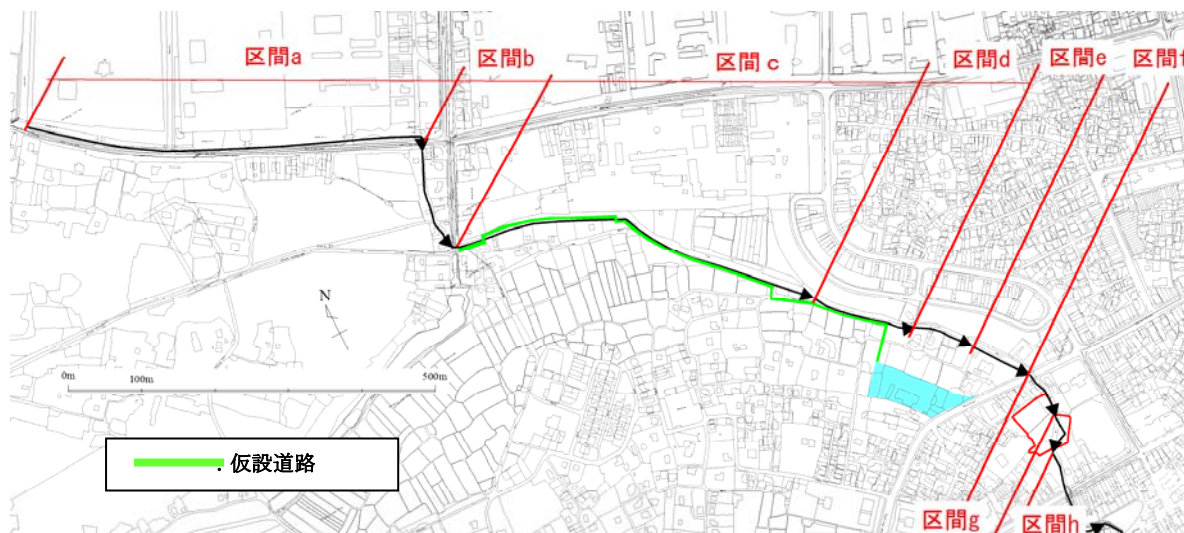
日本橋水路改修用の仮設道路位置図
